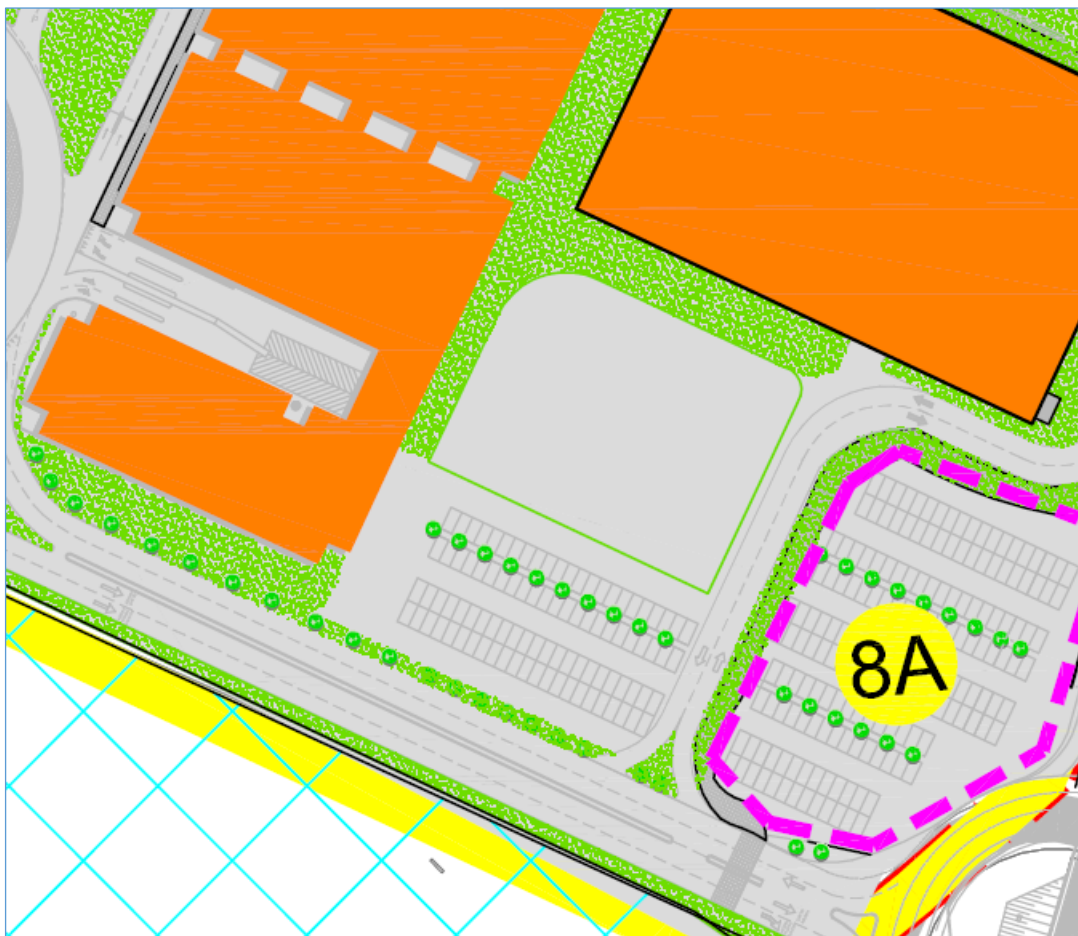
Estratto Master Plan – Intervento riqualificazione Parcheggio Staff
